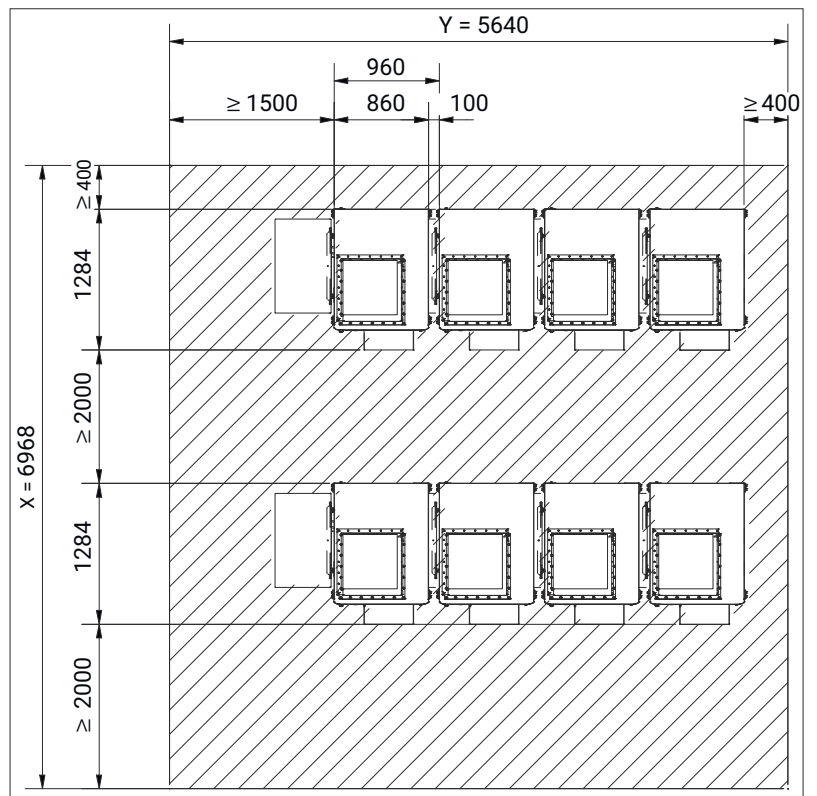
Installationsfläche [mm] Mehrfachsystem Variante 1
